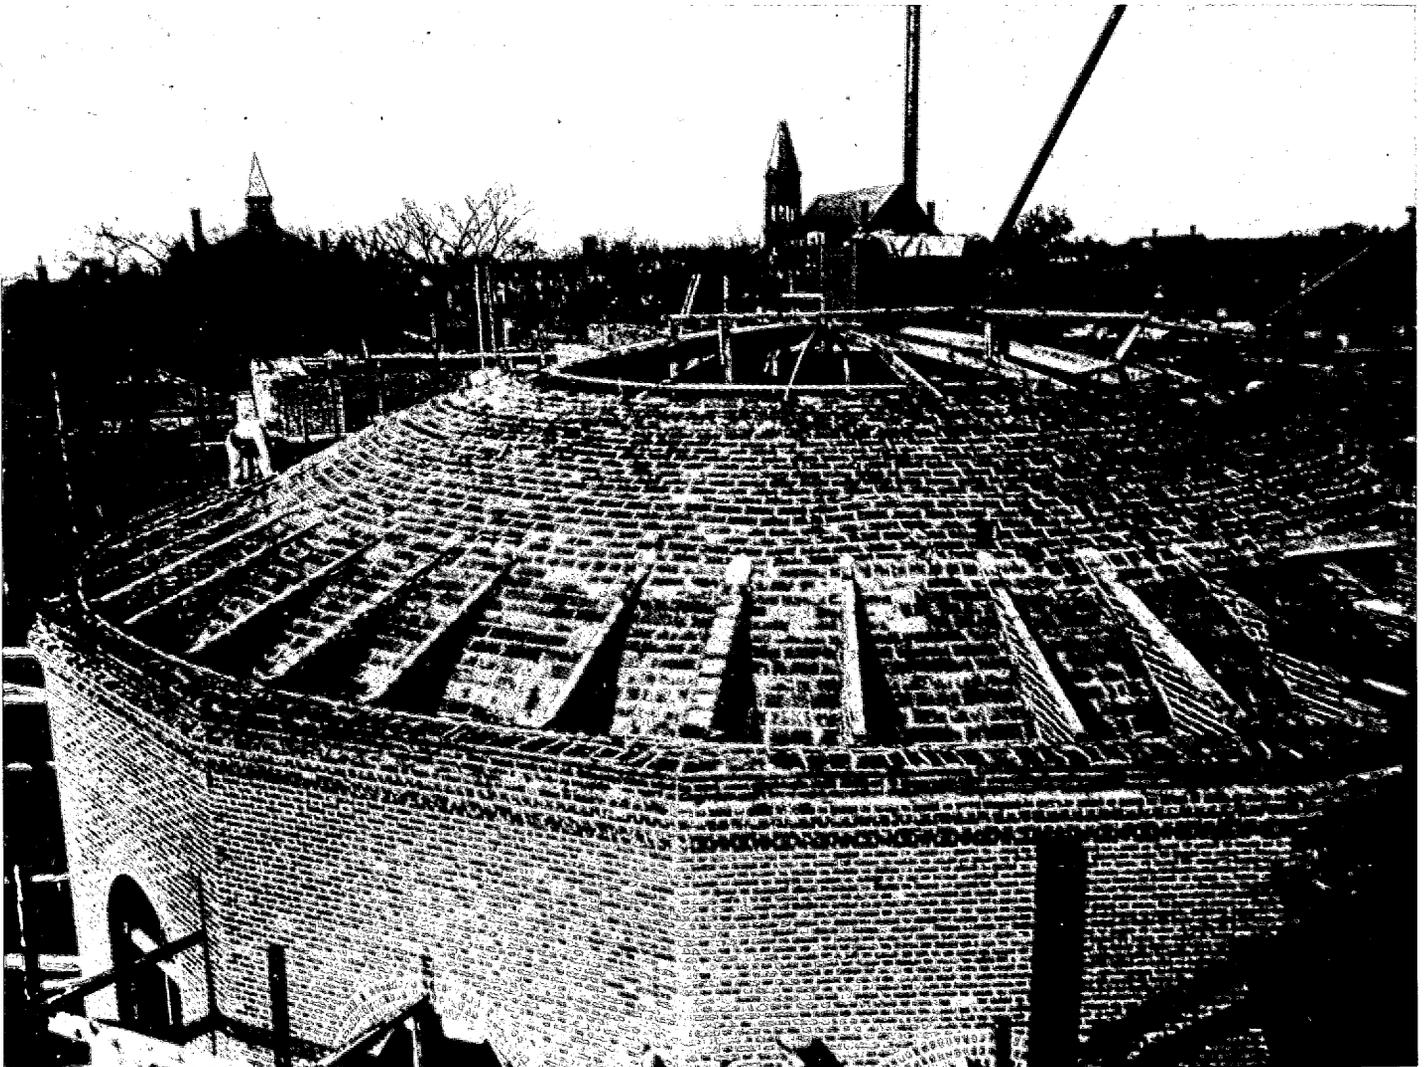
East Boston High School. Boston, Massachusetts 1899.
